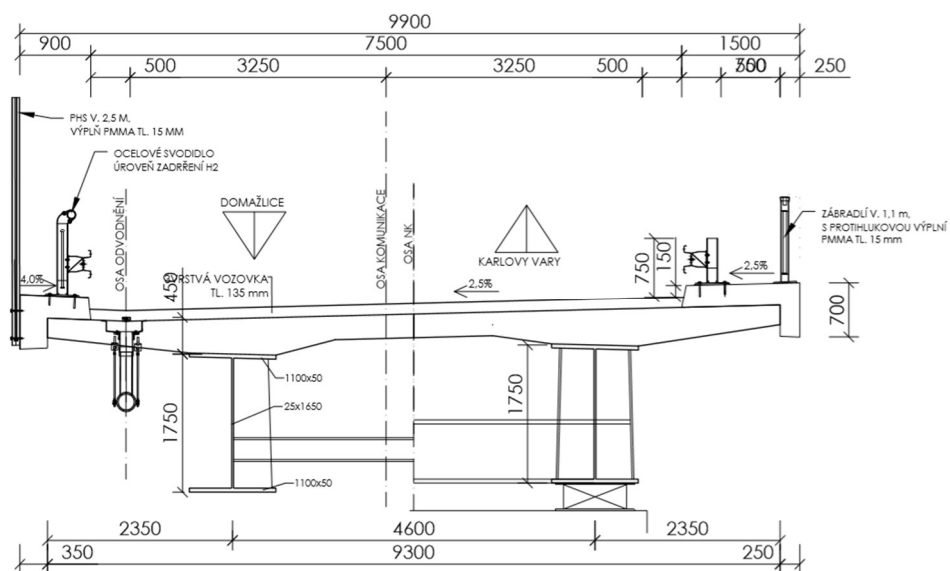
Letmo betonovaná konstrukce – příčný řez
